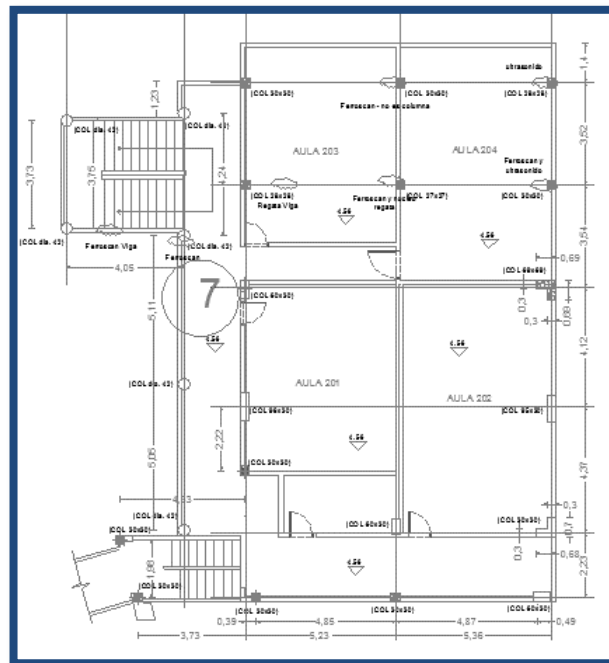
Localización de la lesión en planta del tercer nivel. Fuente: Autores.
